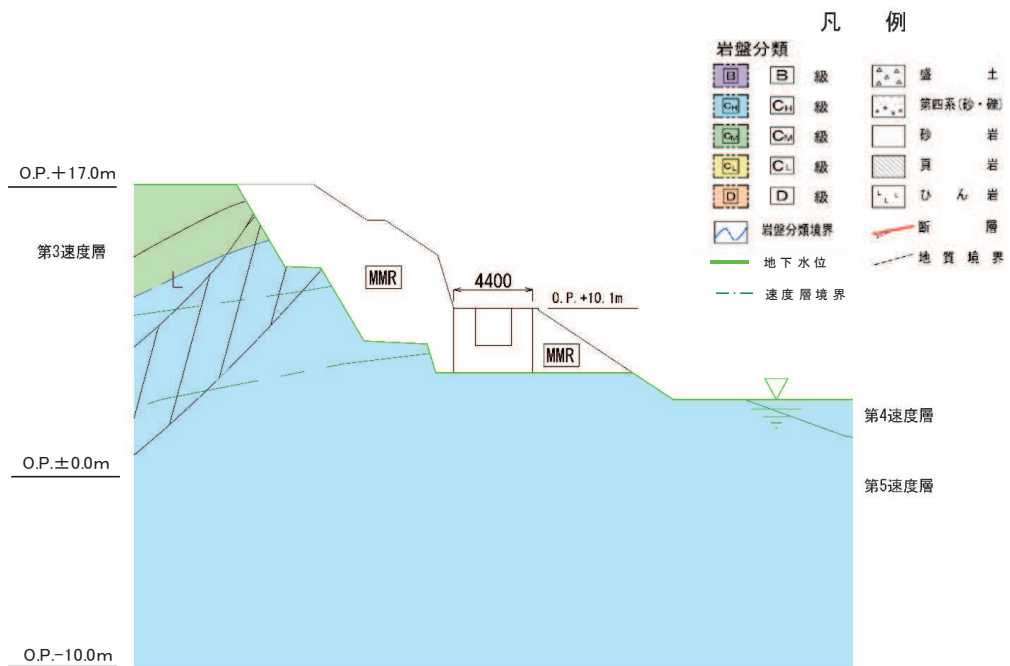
出口側集水ピットの評価対象断面図 (A-A 断面)
